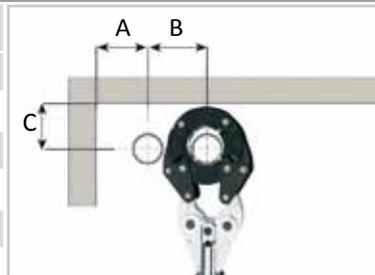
Mindesteinbaumasse für Pressschlinge /- Kette
